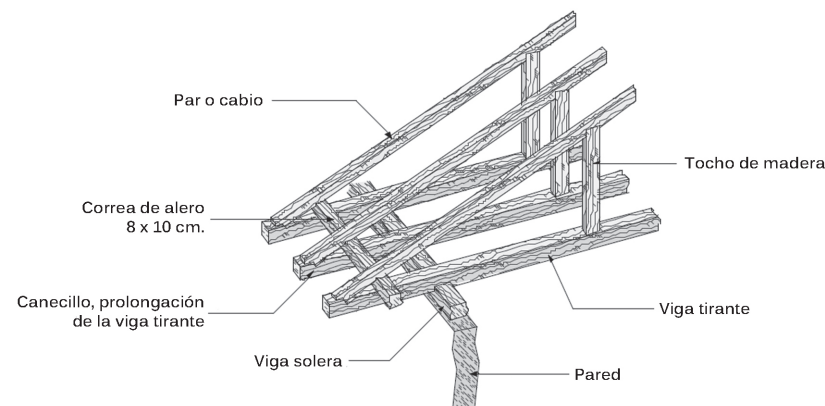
Detalle del alero de una cubierta con canecillos
